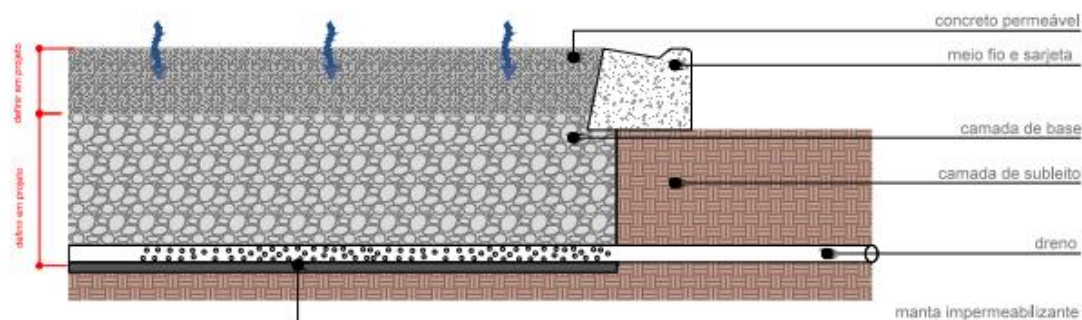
Pavimento com aplicação de concreto permeável sem infiltração no solo
